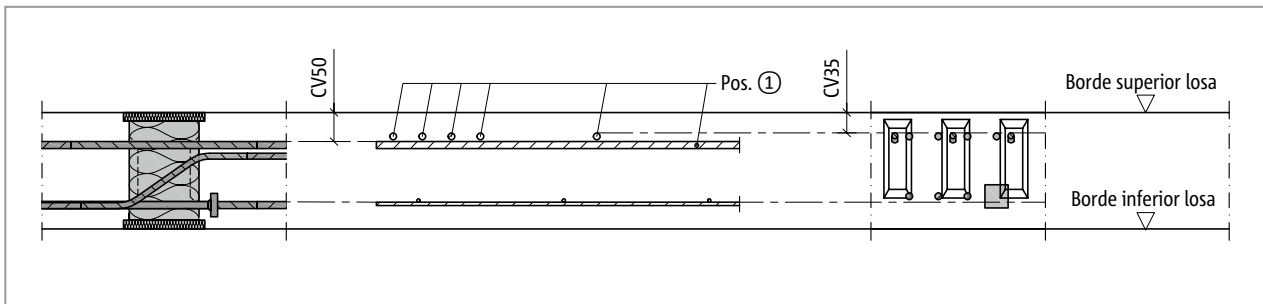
Schöck Isokorb® XT tipo C: Armadura in situ esquinero externo (sección XT tipo C-L-CV50, vista XT tipo C-R-CV35)
